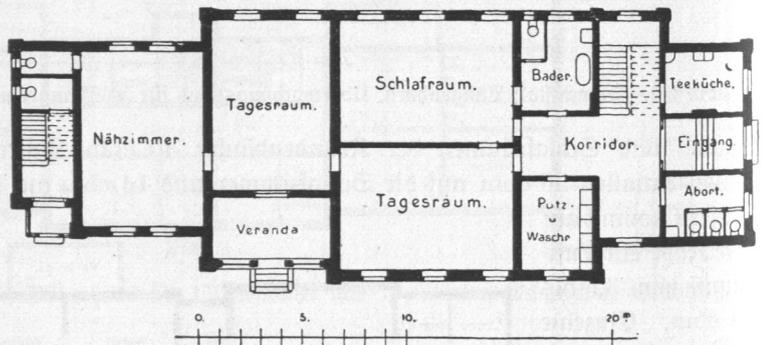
Irrenanstalt Langenhorn, Landhaus für Frauen, Erdgeschoss, Grundriß.
